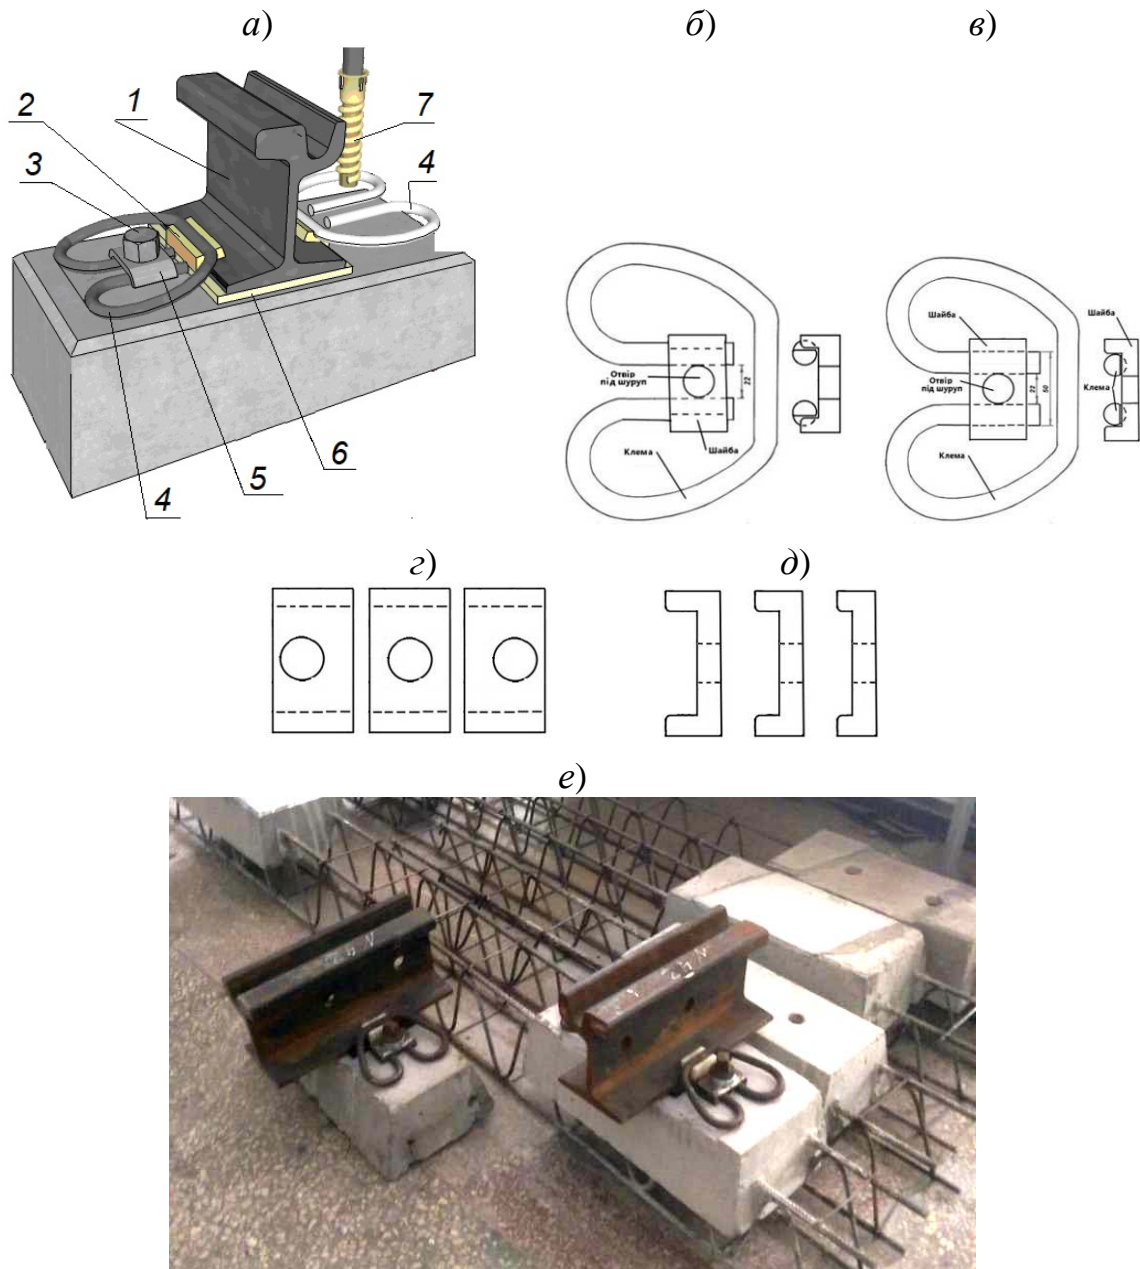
Пружне рейкове скріплення SRS-T для трамвайної колії: *a* – конструкція скріплення у зборі: 1 – рейка; 2 – ізолюючий вкладиш; 3 – шуруп; 4 – пружна клема; 5 – П-подібна шайба; 6 – підрейкова прокладка; 7 – полімерний дюбель; *б* – варіант із заходом полиць притискної шайби у вертикальні пази у прямих кінцях клеми; *в* – варіант із заходом стінки притискної шайби у горизонтальні пази у прямих кінцях клеми; *г* – типорозміри притискної шайби за положенням отвору в поперечному відносно рейки напрямку; *д* – типорозміри притискної шайби за висотою полиць; *е* – двоблокові опорні елементи зі скріпленнями SRS-T збірно-монолітної підрейкової основи із збірних залізобетонних блоків та монолітної плити дослідної партії у галузевій науково-дослідній лабораторії підрейкових основ і спецзалізобетону УкрДУЗТ
